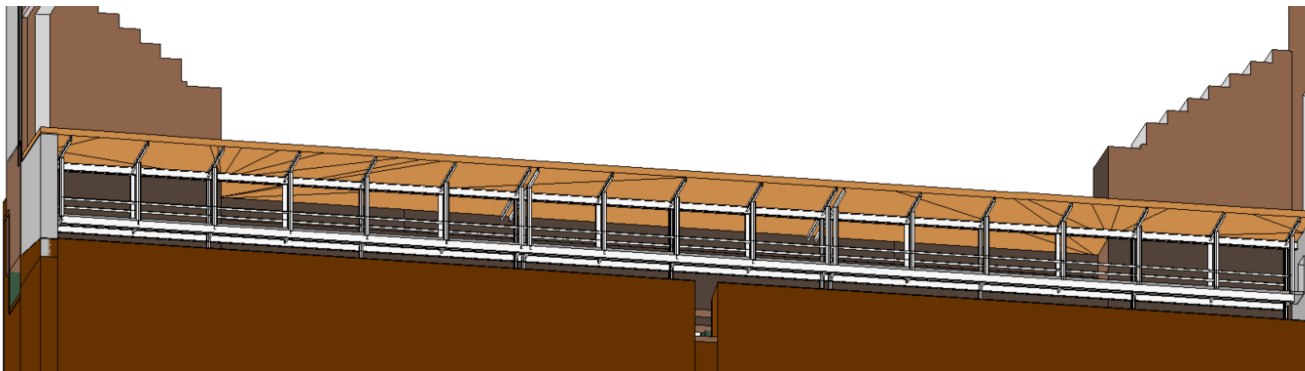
Plataforma construida en el *Hyposcaenium* bajo la escena. Estructura formada por pilares y vigas metálicas.
